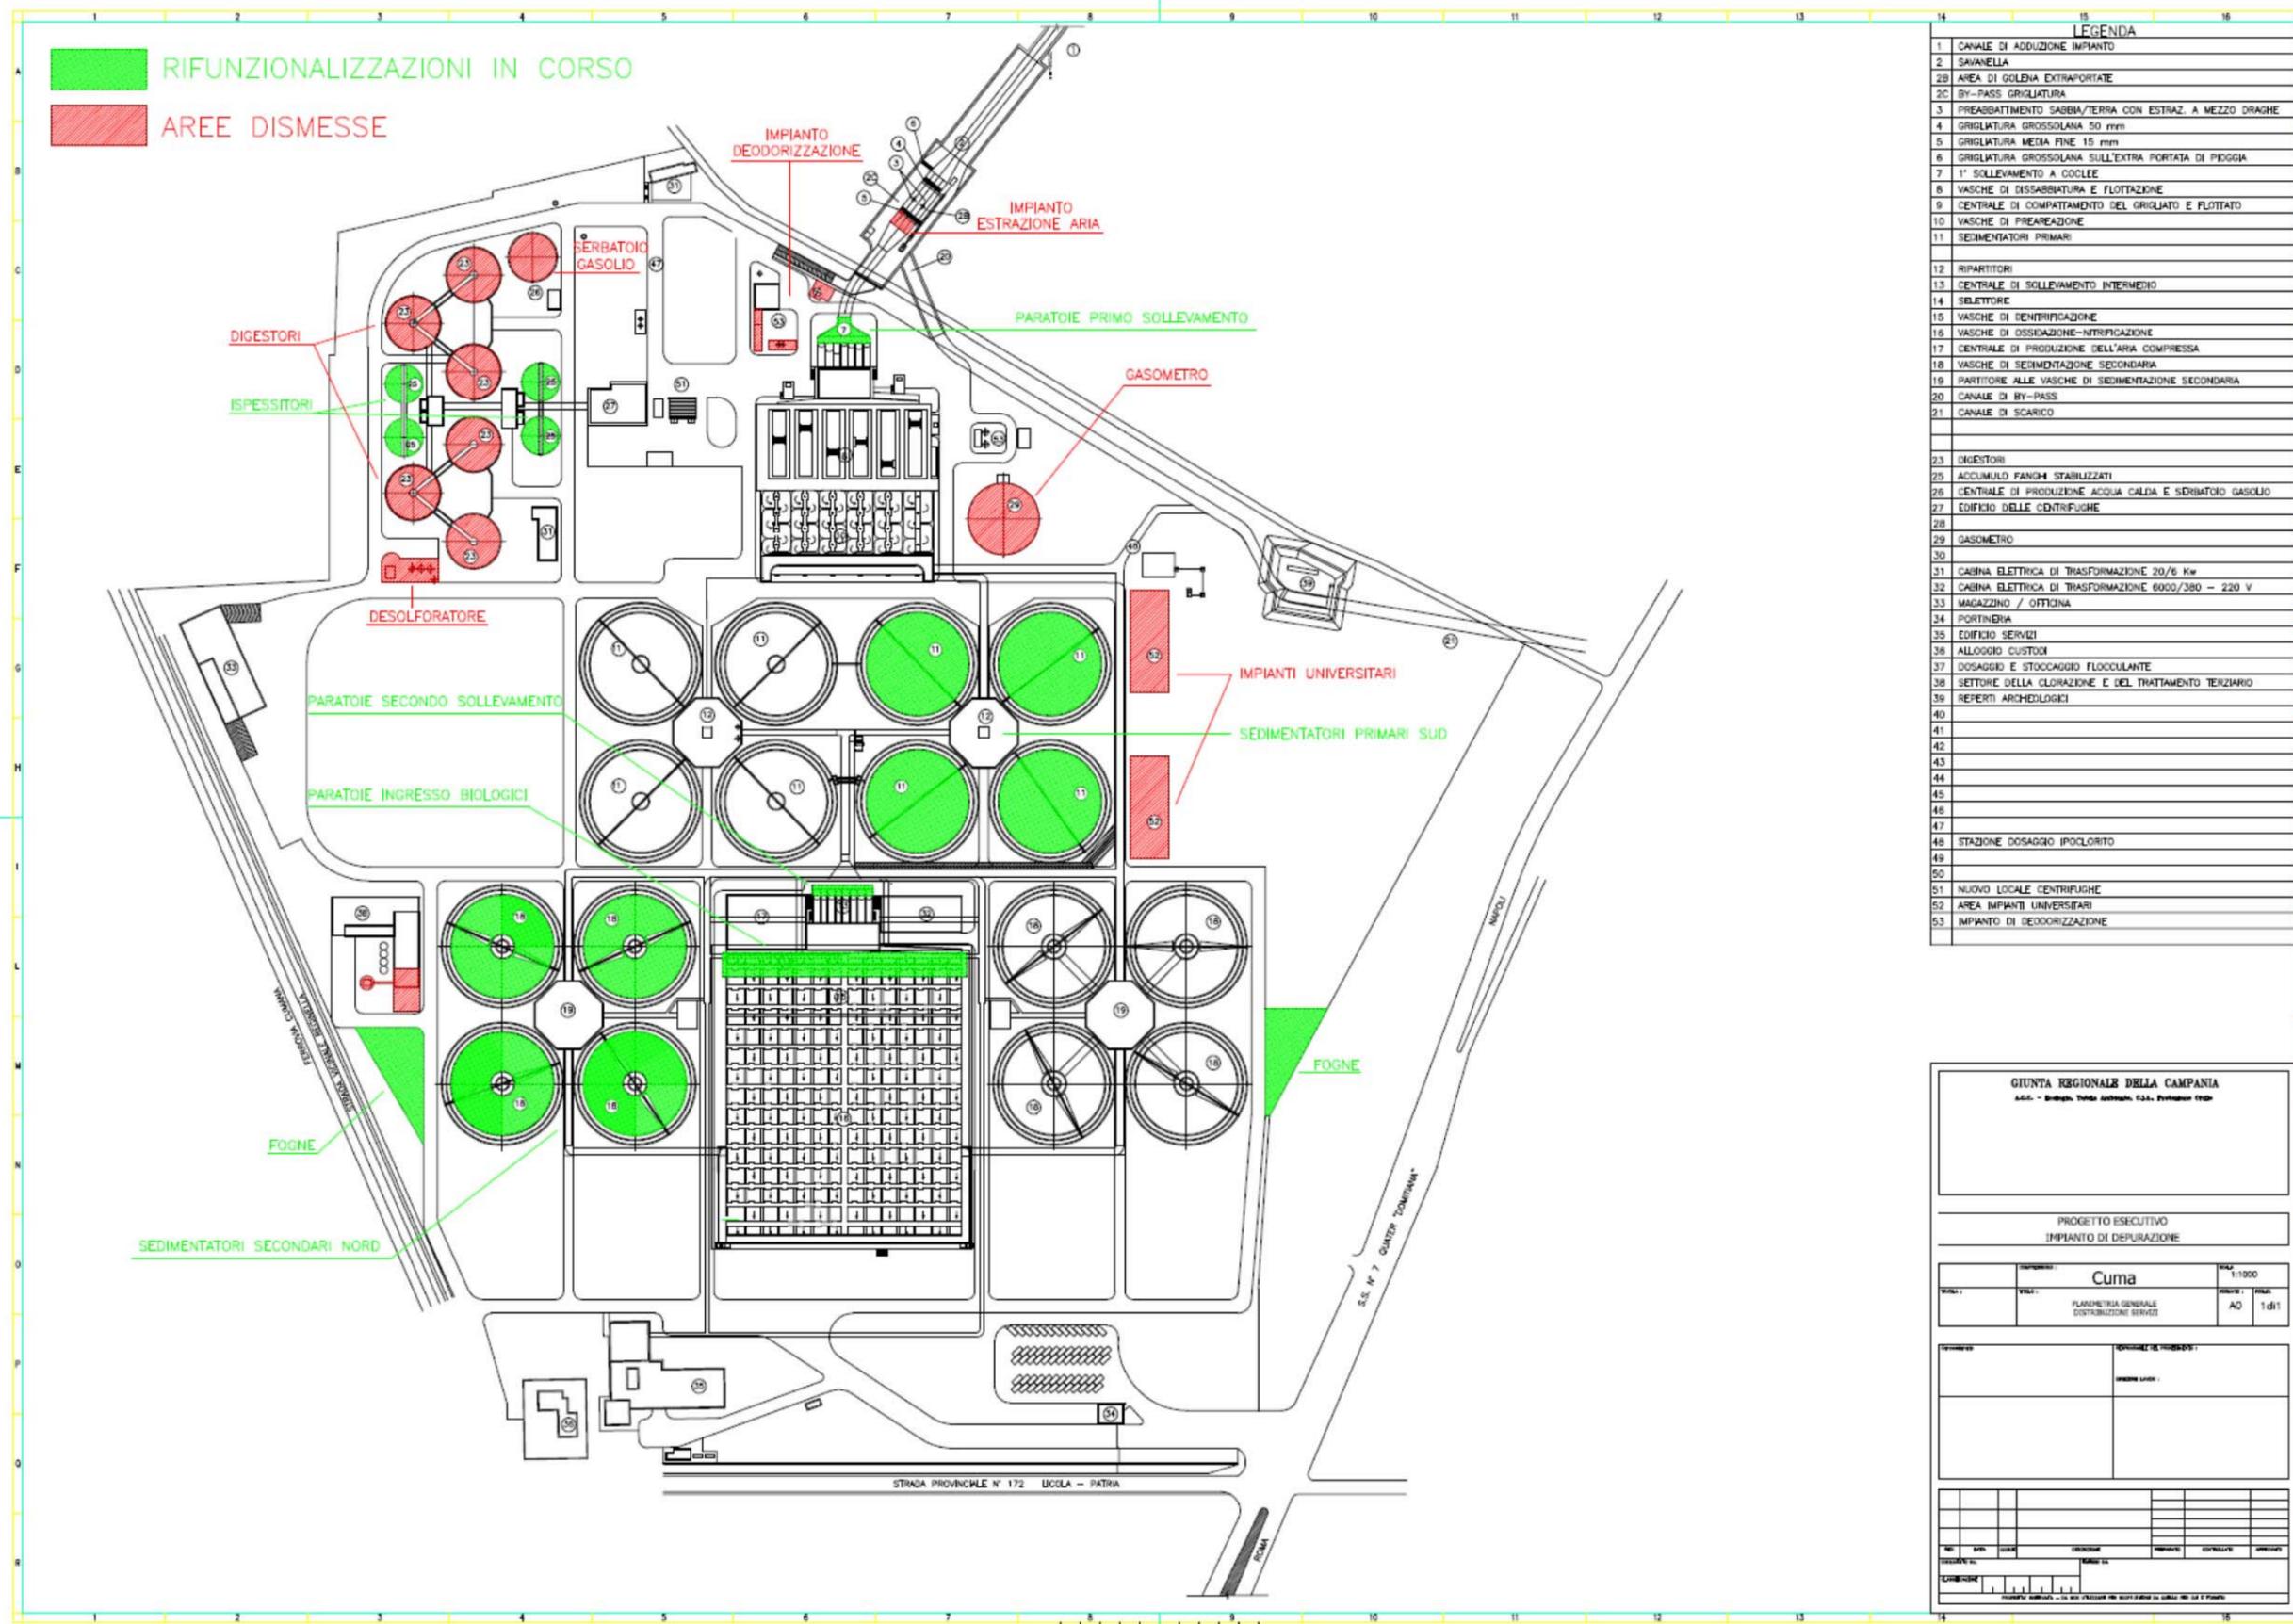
Planimetria con indicazione delle aree di intervento
